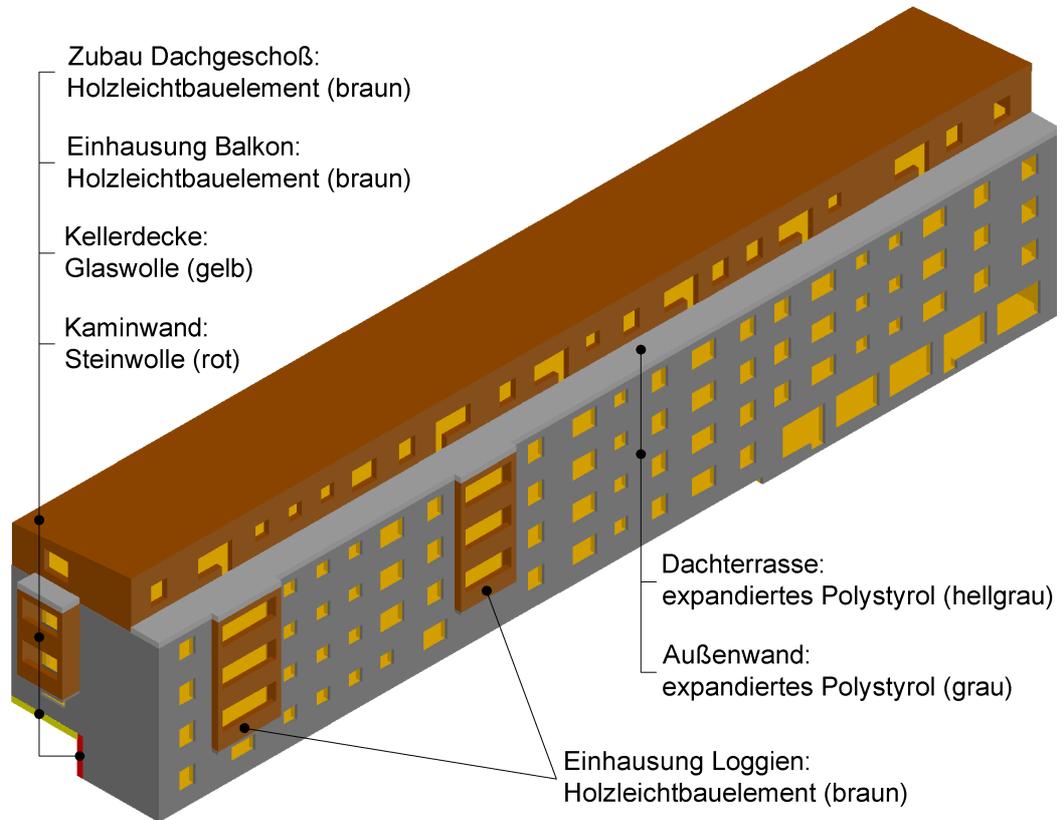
Sanierungsmaßnahmen für die Gebäudeteile der thermischen Gebäudehülle bei der Sanierungsvariante *Niedrigenergiehaus mit Dachgeschoß
